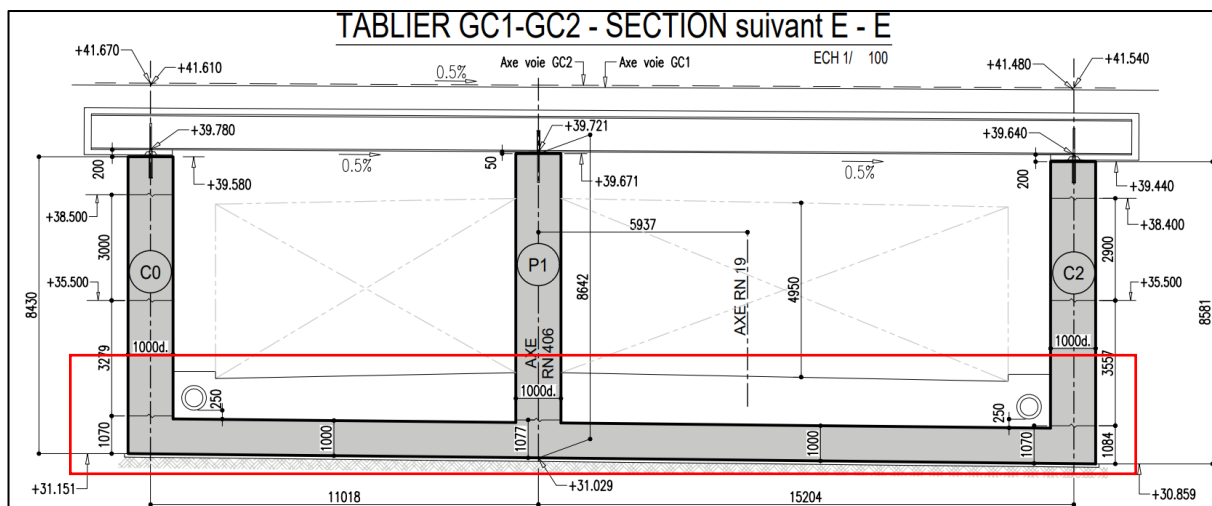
Coupe ouvrage SNCF (DOE plan : RN406-M04-SEC-DOE-COF-33101-H- Structure en U – coffrage)
